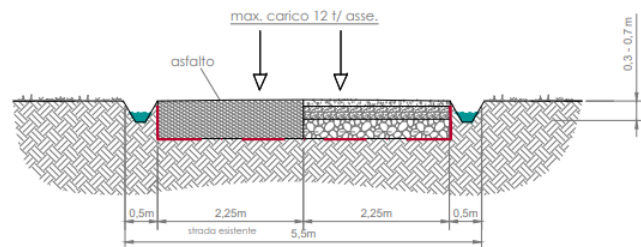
Sezione stradale tipo a doppia scarpata (in rilevato)
